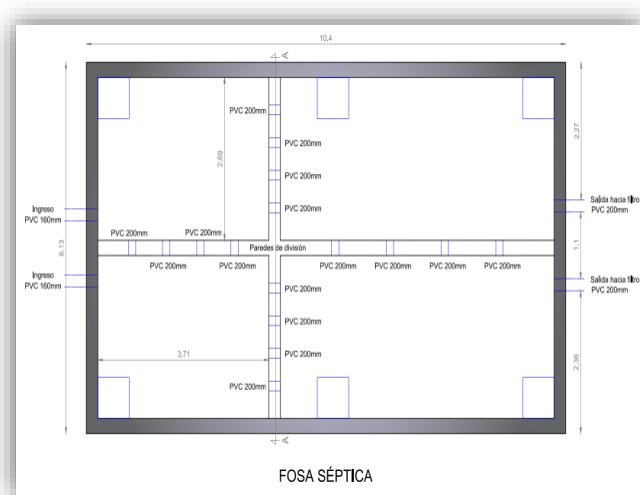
Gráfico en planta del tanque de sedimentación primaria (Ver anexo 1)
